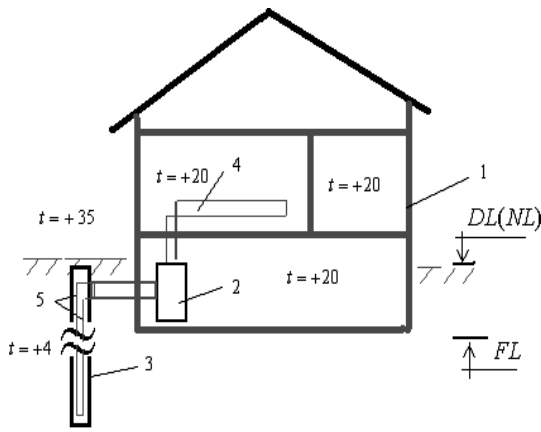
Схема использования теплового насоса для кондиционирования воздуха: 1 – охлаждаемое здание; 2 – тепловой насос; 3 – U-подобный зонд (конденсатор); 4 – обогревательный прибор (испаритель); 5 – трубки теплообменника
